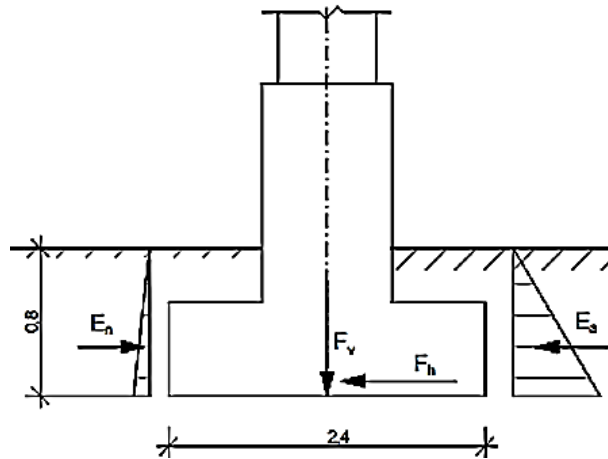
Розрахункова схема для розрахунку фундаменту на зсув по підшві
